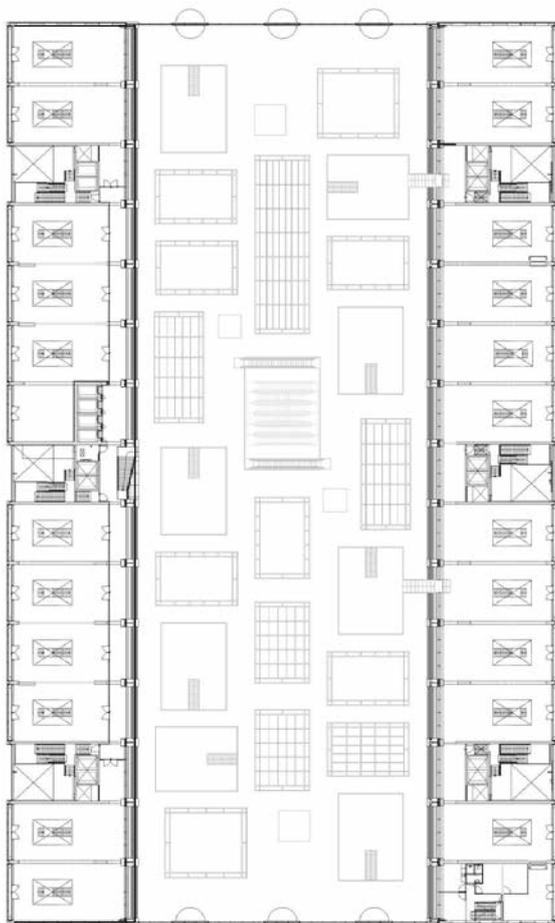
Markthalle MVRDV, Rotterdam, Grundriss
